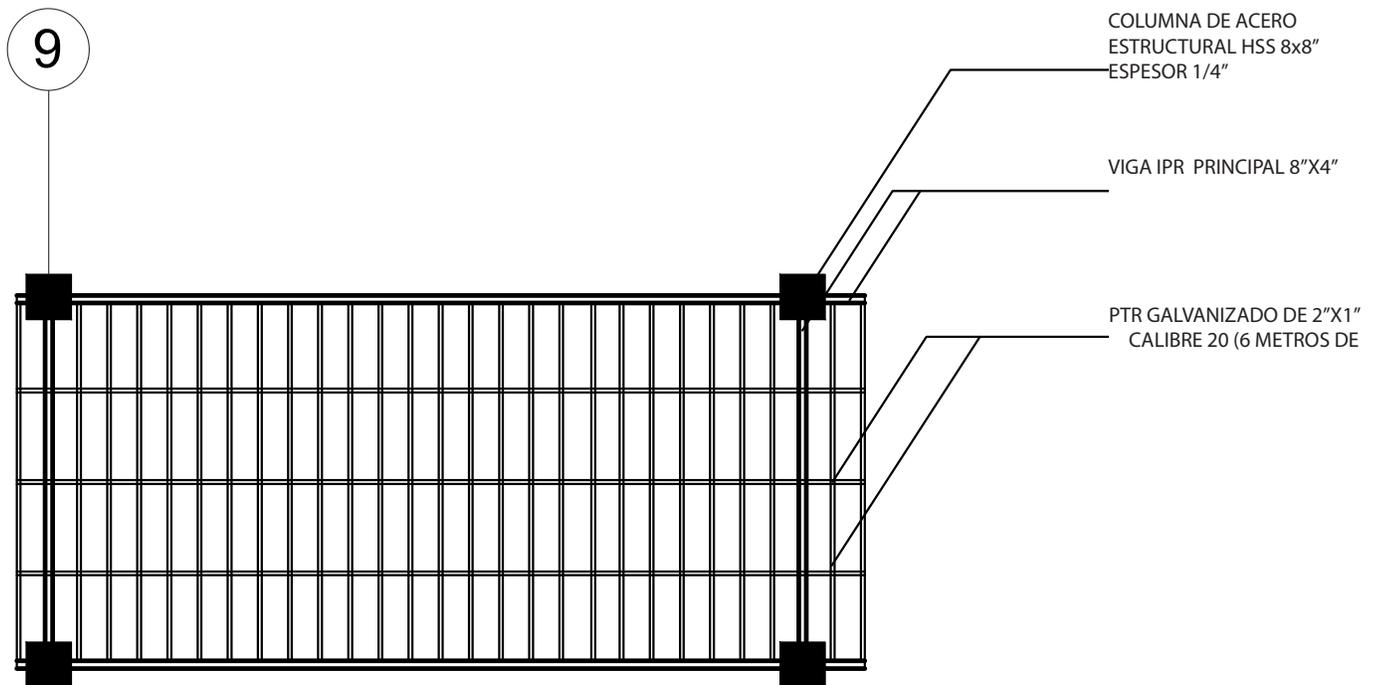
Detalle 5. Bastidor y vigas IPR para piso falso y columnas de acero
